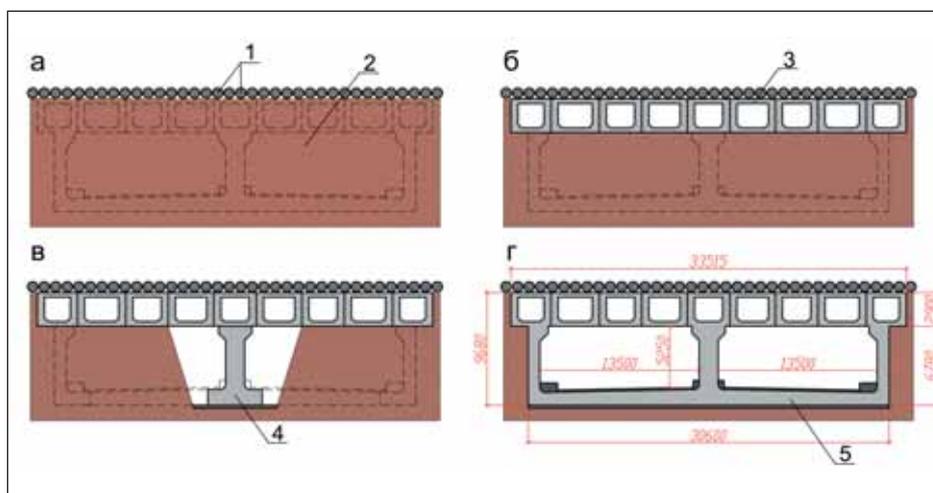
Последовательность (а–г) сооружения участка Балтийского тоннеля: 1 – трубы защитного экрана; 2 – закрепленный массив грунта; 3 – продольные коробчатые элементы перекрытия; 4 – промежуточная стена тоннеля; 5 – лотковая плита тоннельной обделки
